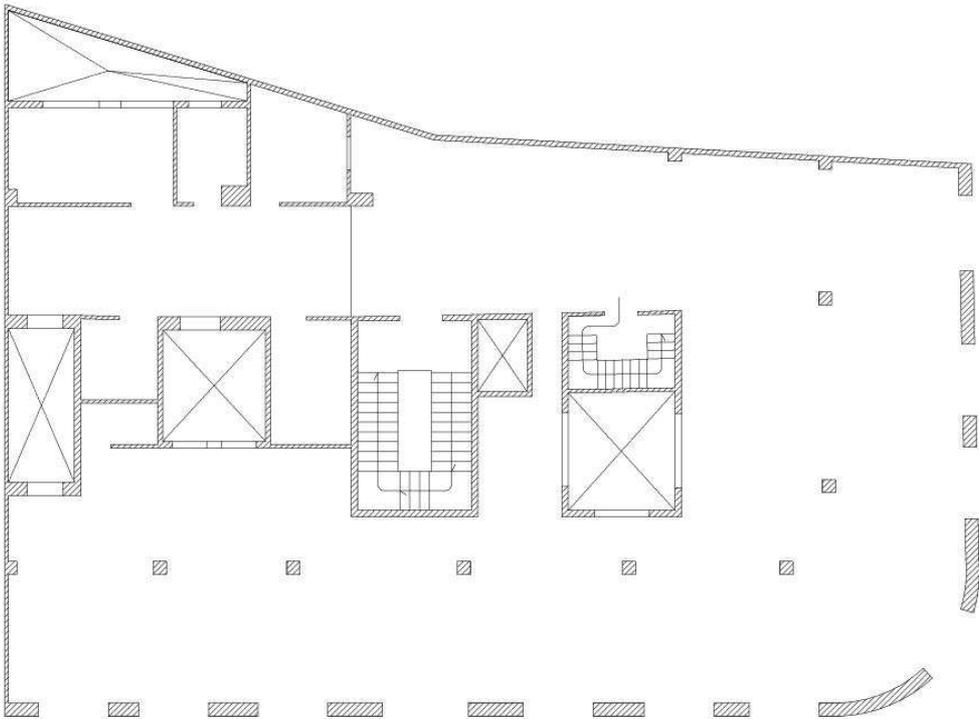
Levantamiento CAD Planta baja Edificio Niederleytner. Fuente: Elaboración propia.
